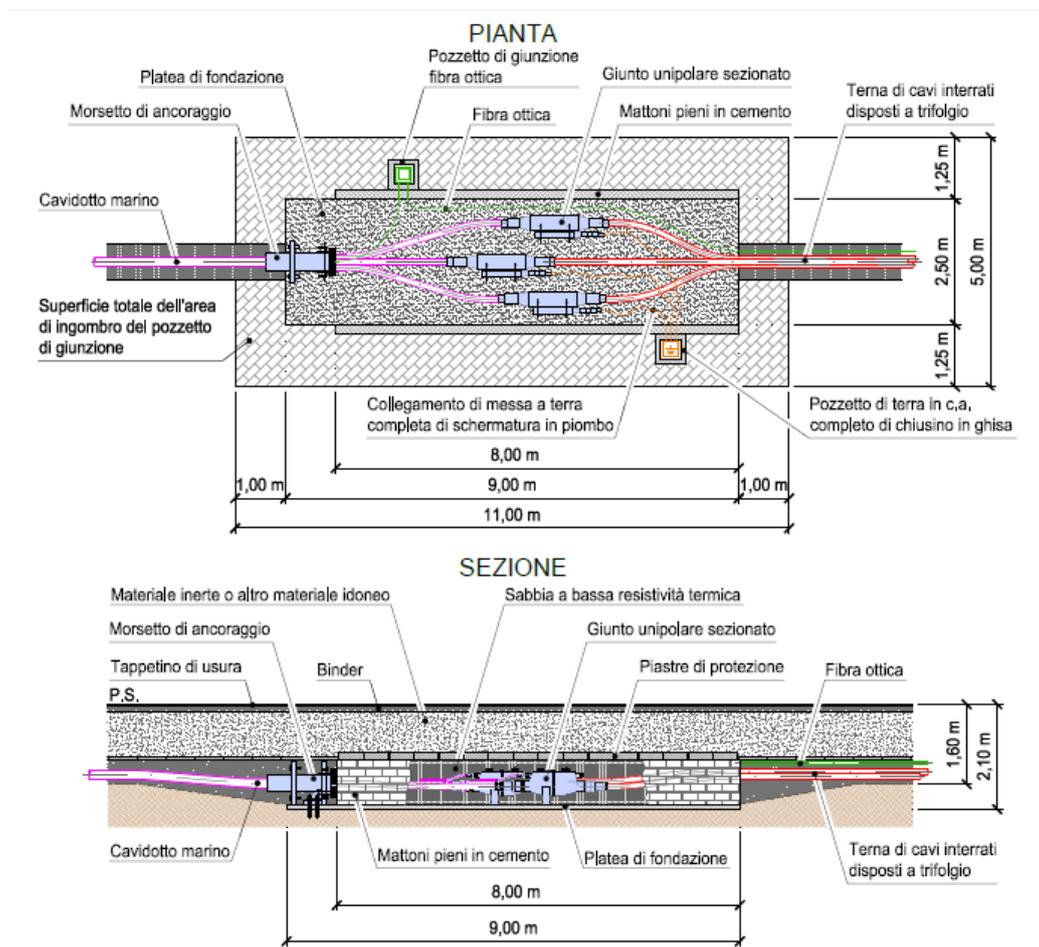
Pianta e sezione tipiche del pozzetto di giunzione. Elaborazione iLStudio
